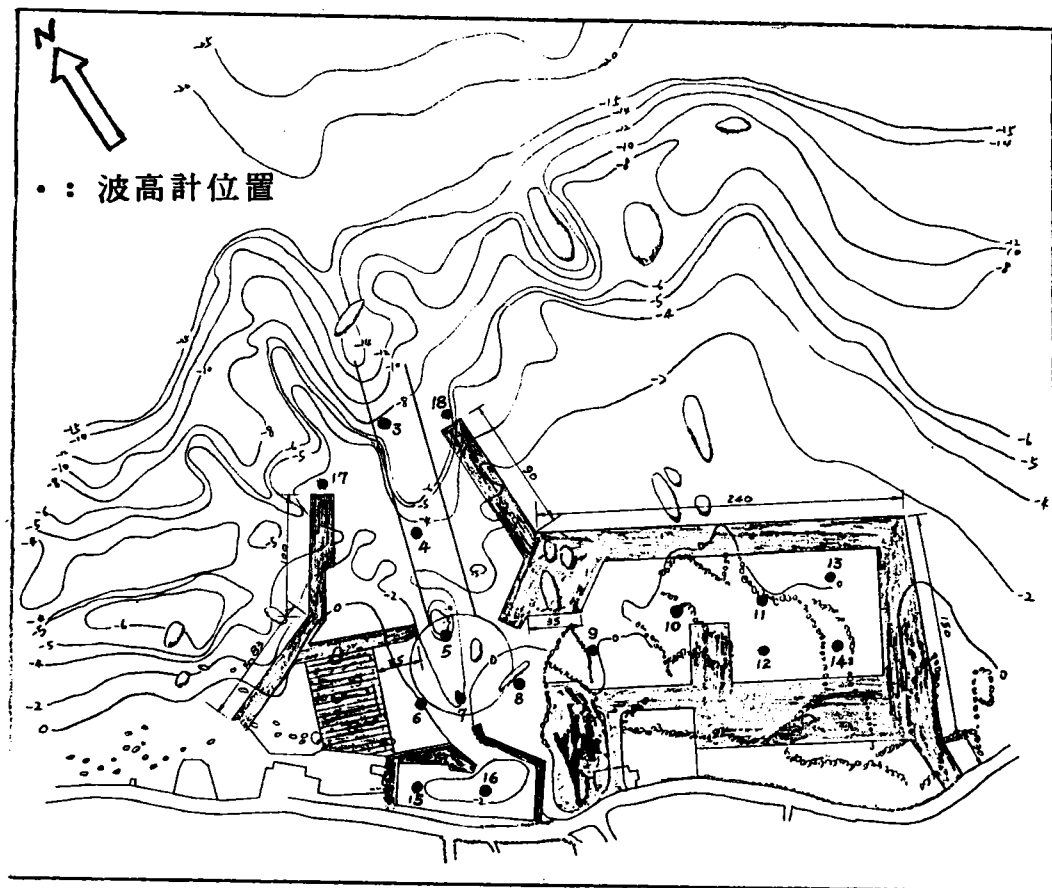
南雅船澳附近地形與試驗配置方案 1 平面示意圖
